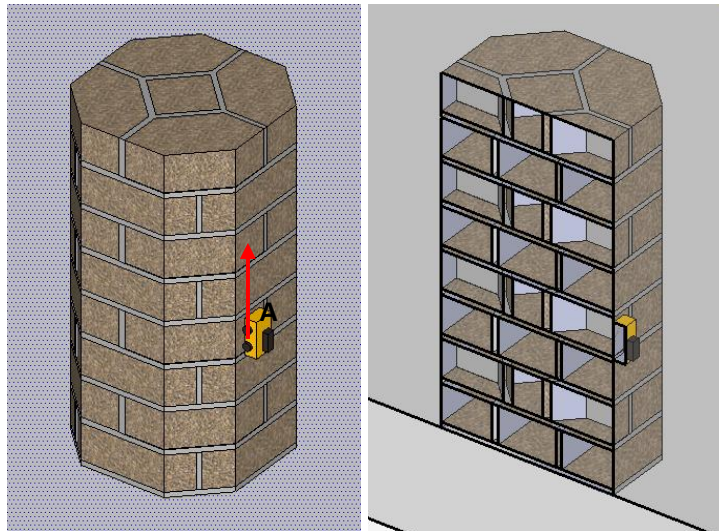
Modelo BIM (*Building Information Modeling*) de la columna. a) Ubicación del perfil de georadar, b) Sección de la columna en la línea del perfil, mostrando la posición de la sillería de piedra.
